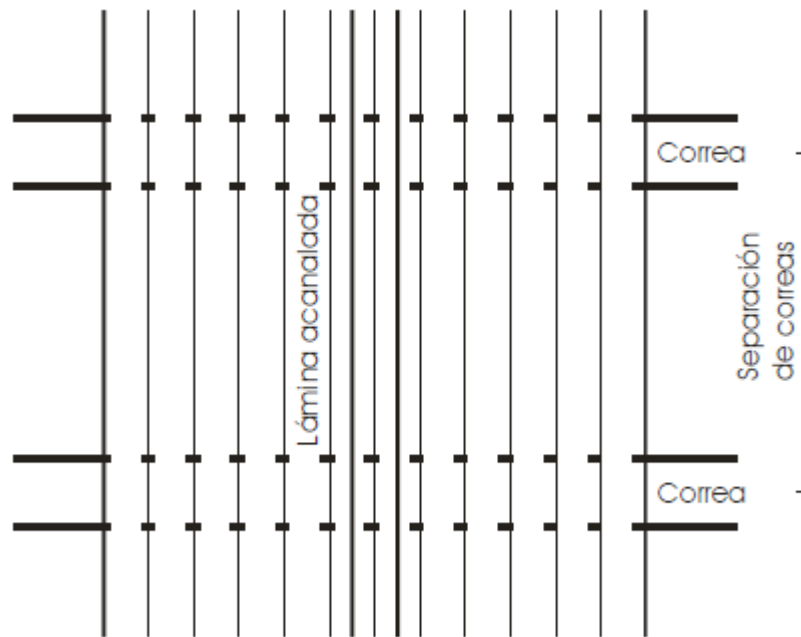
Planta de las láminas acanaladas sobre los elementos de apoyo. Fuente: (MEDINA M., 2013, pág. 7)
